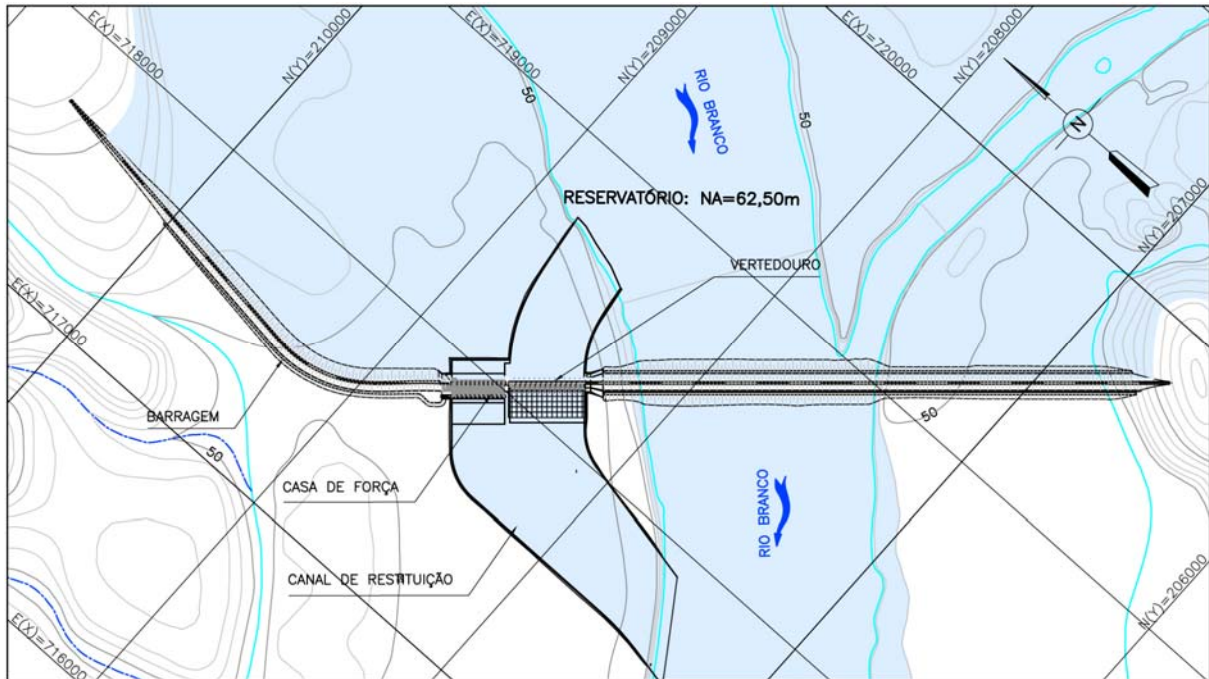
Arranjo Geral do AHE Bem Querer J1 A - Planta
